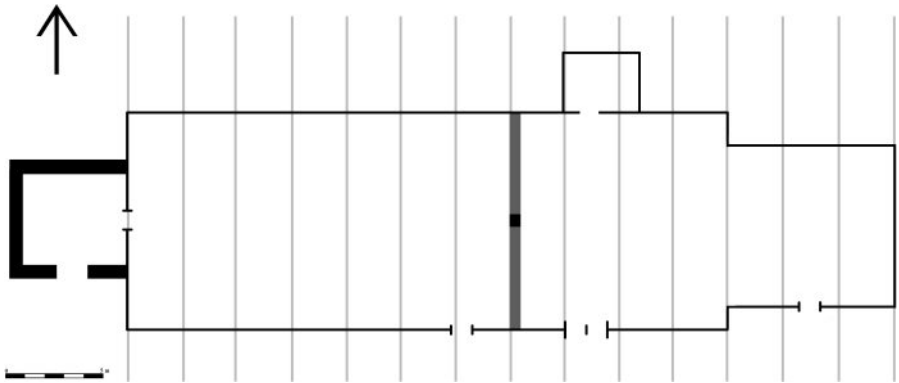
Grundriss der 2. Hohensteiner Kirche anhand der schriftlichen und bildlichen Quellen
